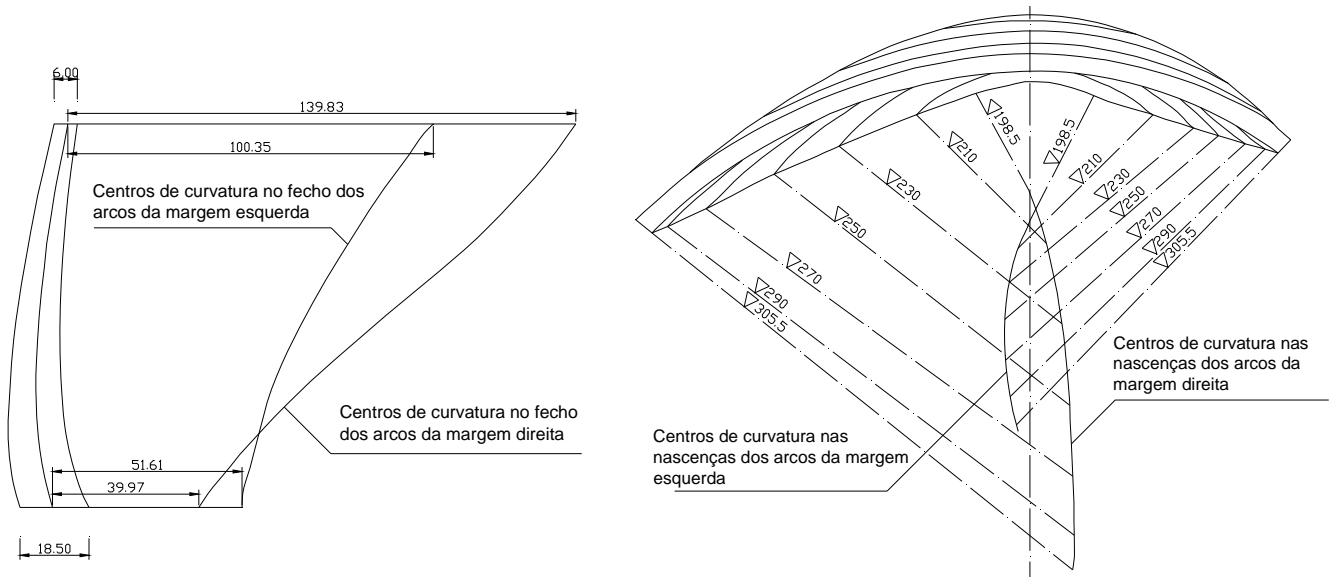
Vista em planta e secção transversal (adaptado de (Li, 2007))
